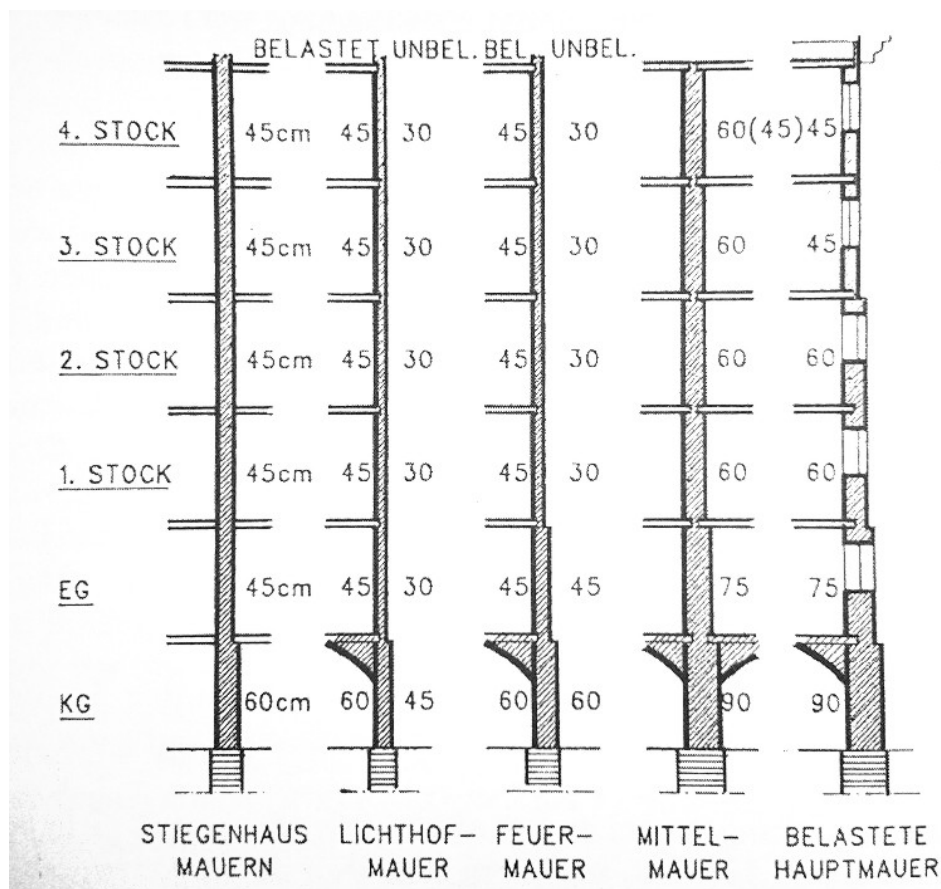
Kolbitsch, Dachgeschoßausbau in Wien, Wien 2008
